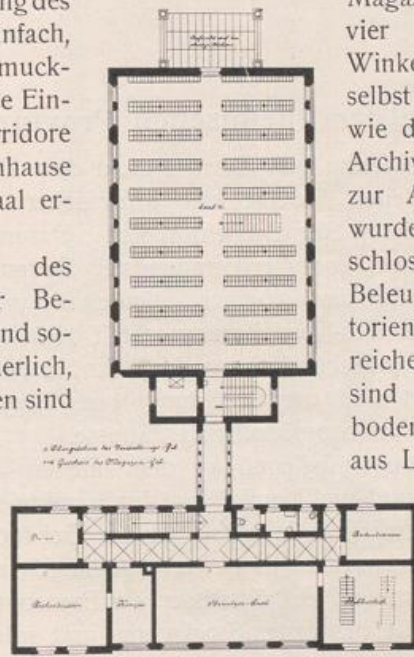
Grundriss des Staatsarchivs.
